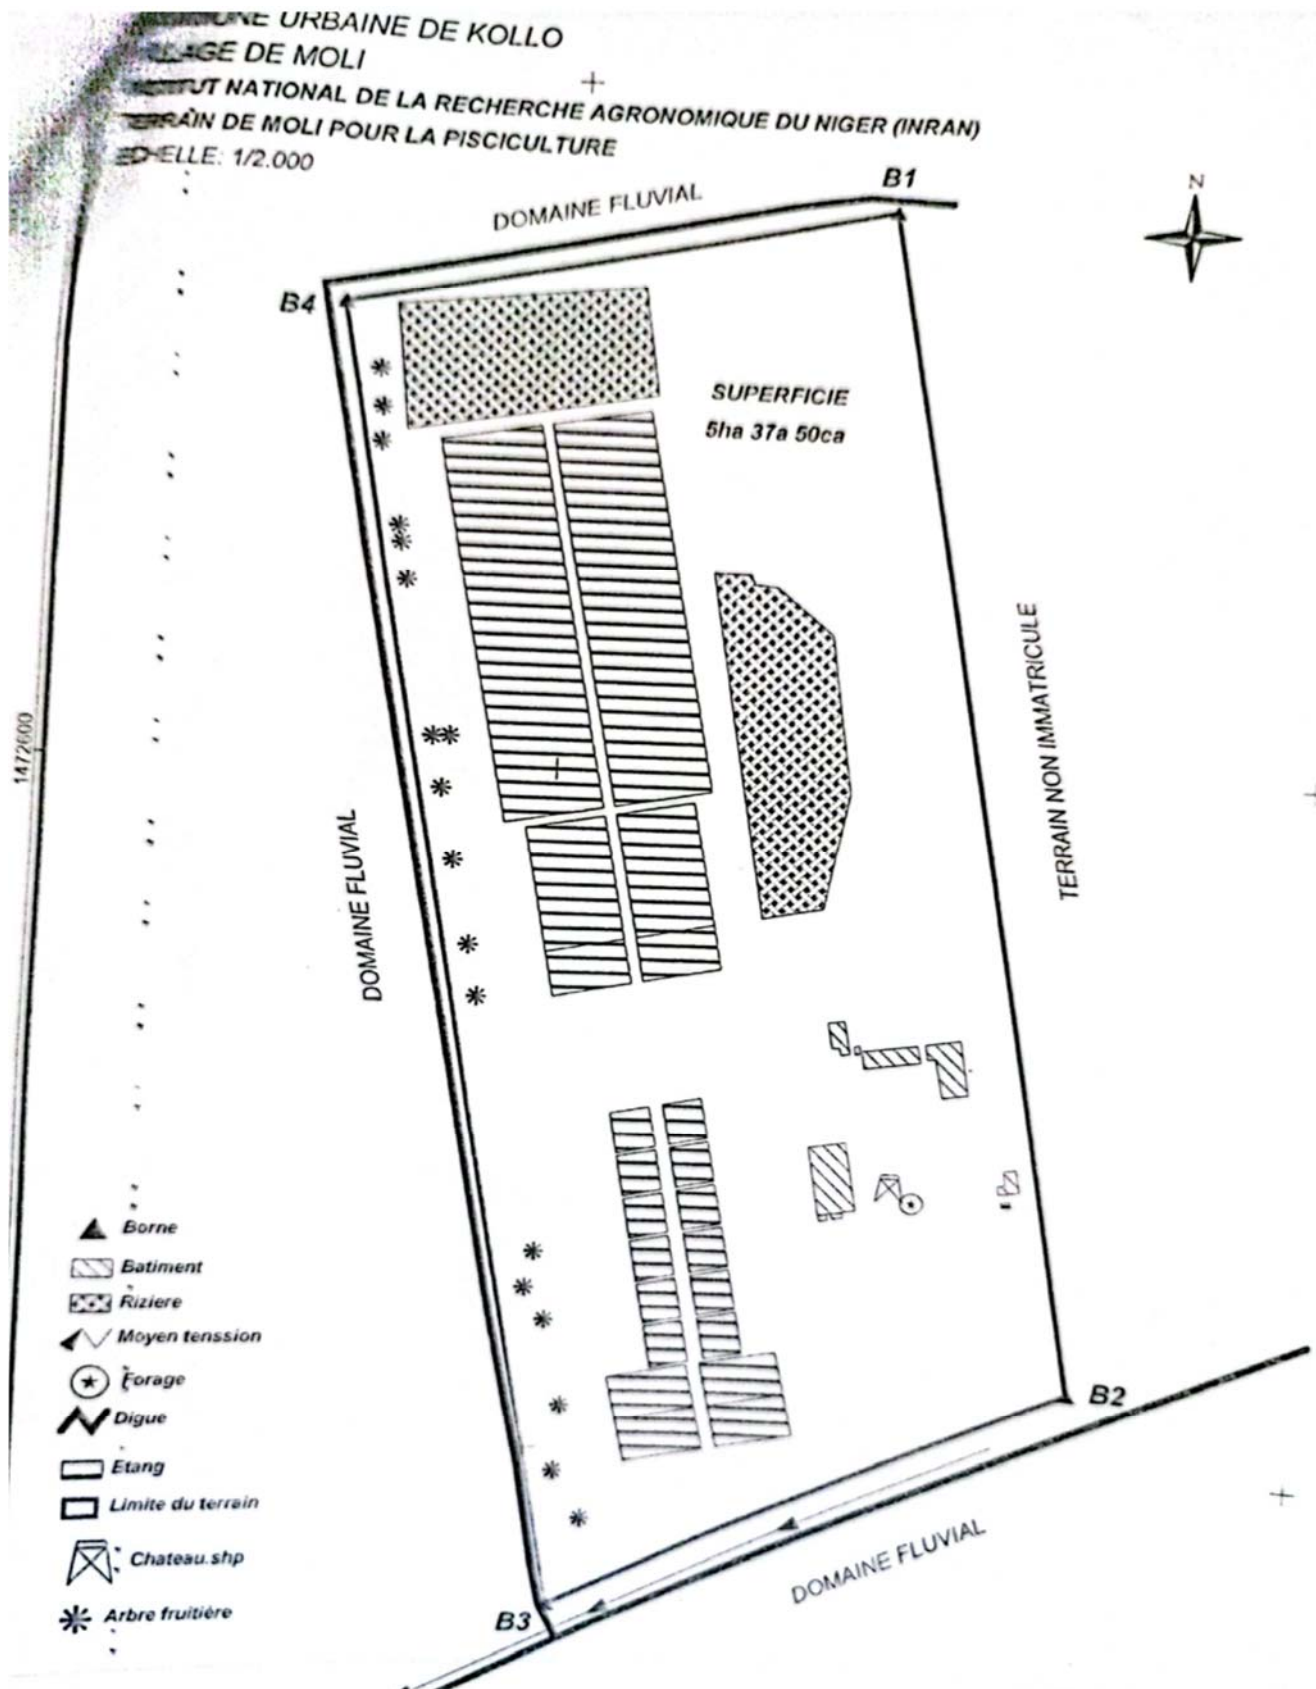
Plan de masse du centre d'alevinage de Moli.
